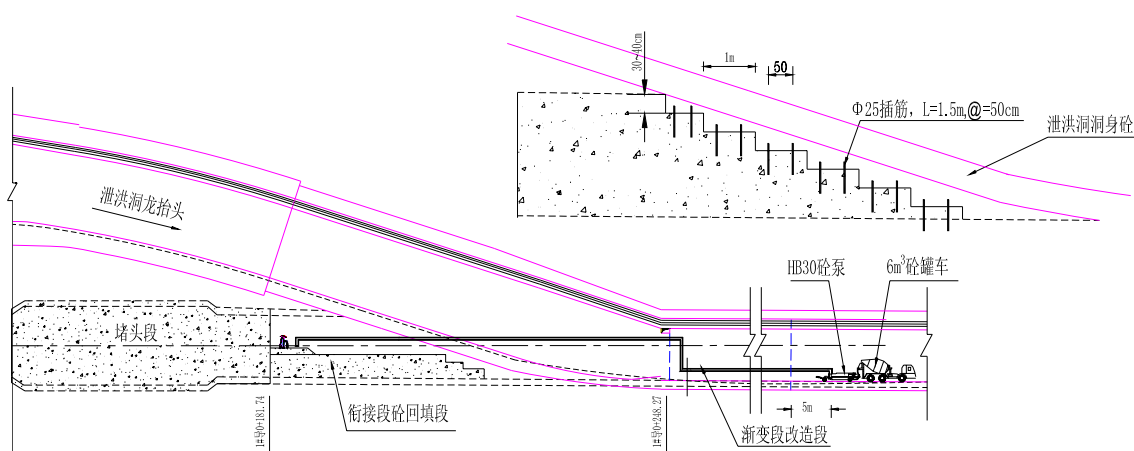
泄洪洞与导流洞衔接段砼回填施工示意图
